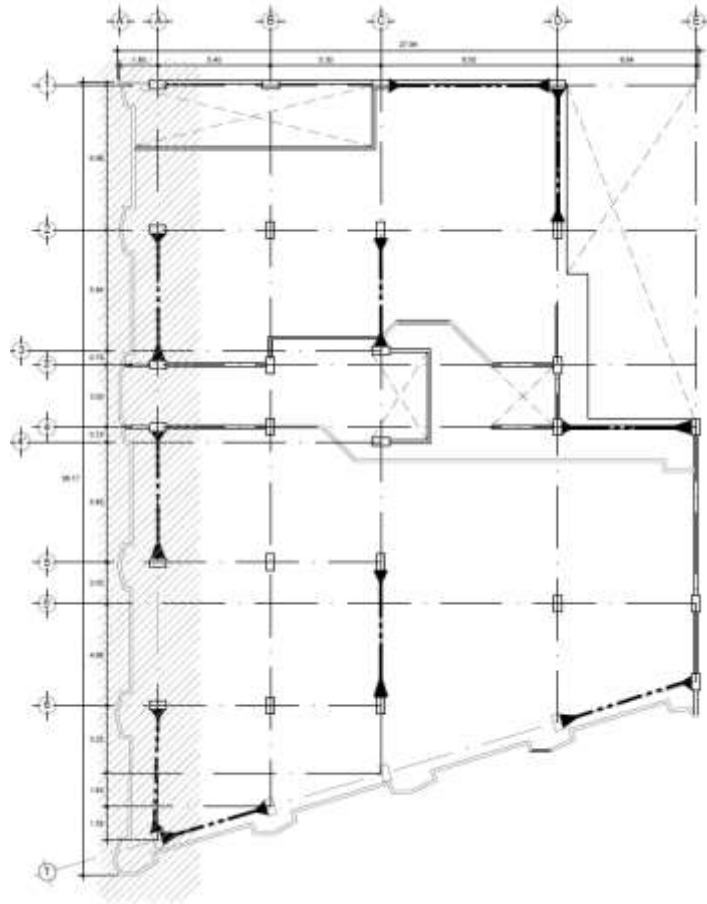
Distribución de contraventeos en planta, Proyecto estructural.
